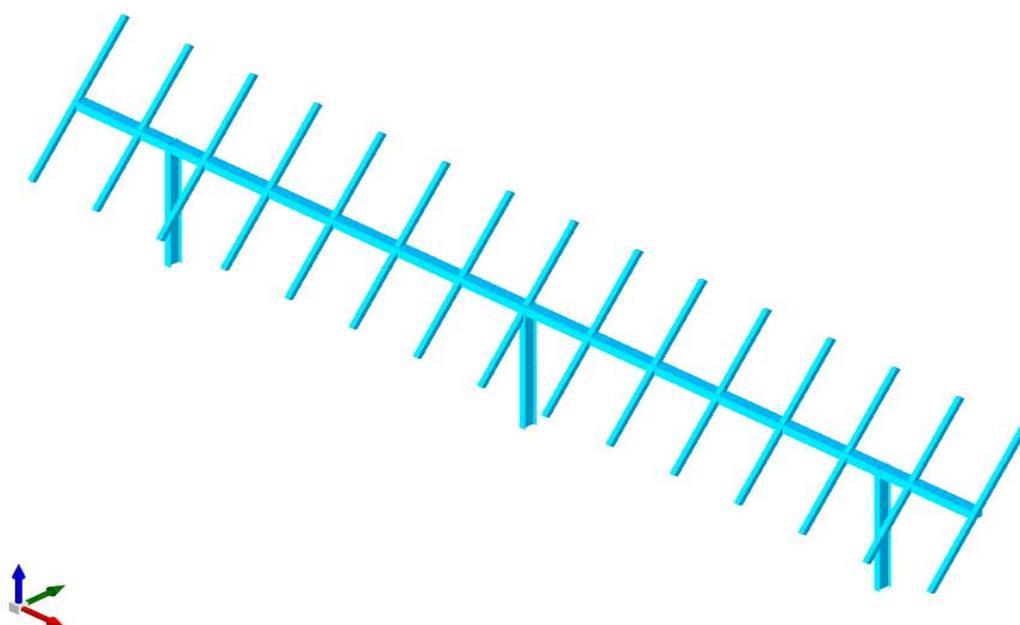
Vista assonometrica modello strutturale con posizione della “vela” inclinata di 55°
